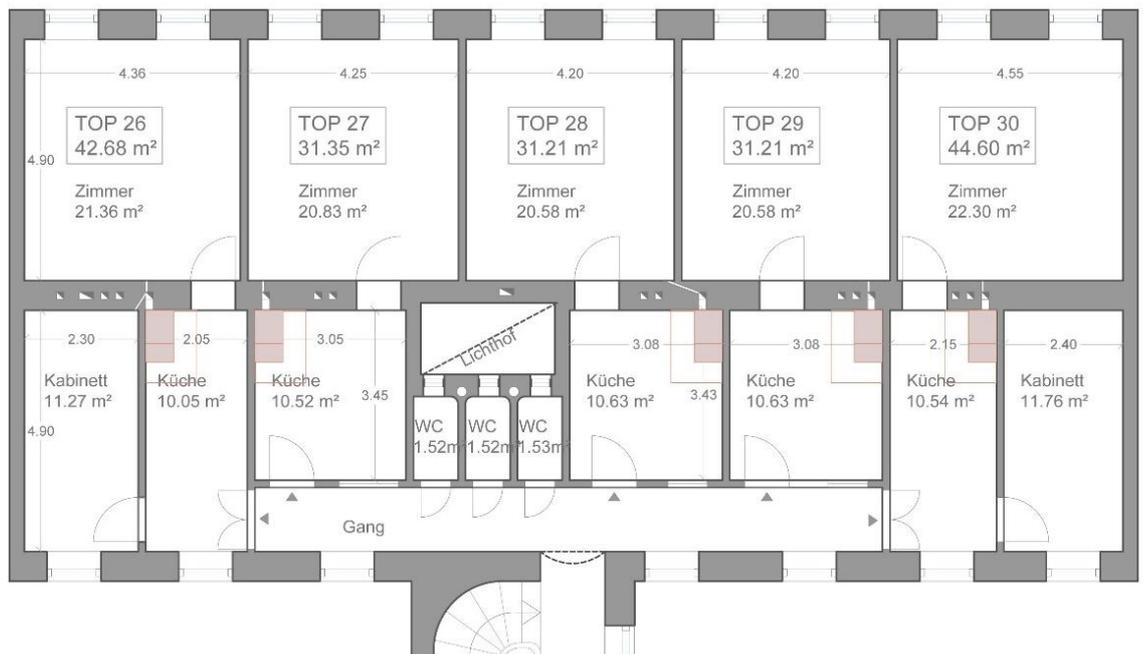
Grundriss Hinterhaus, 1. Obergeschoss, Vorgartenstr. 67, 1200 Wien
